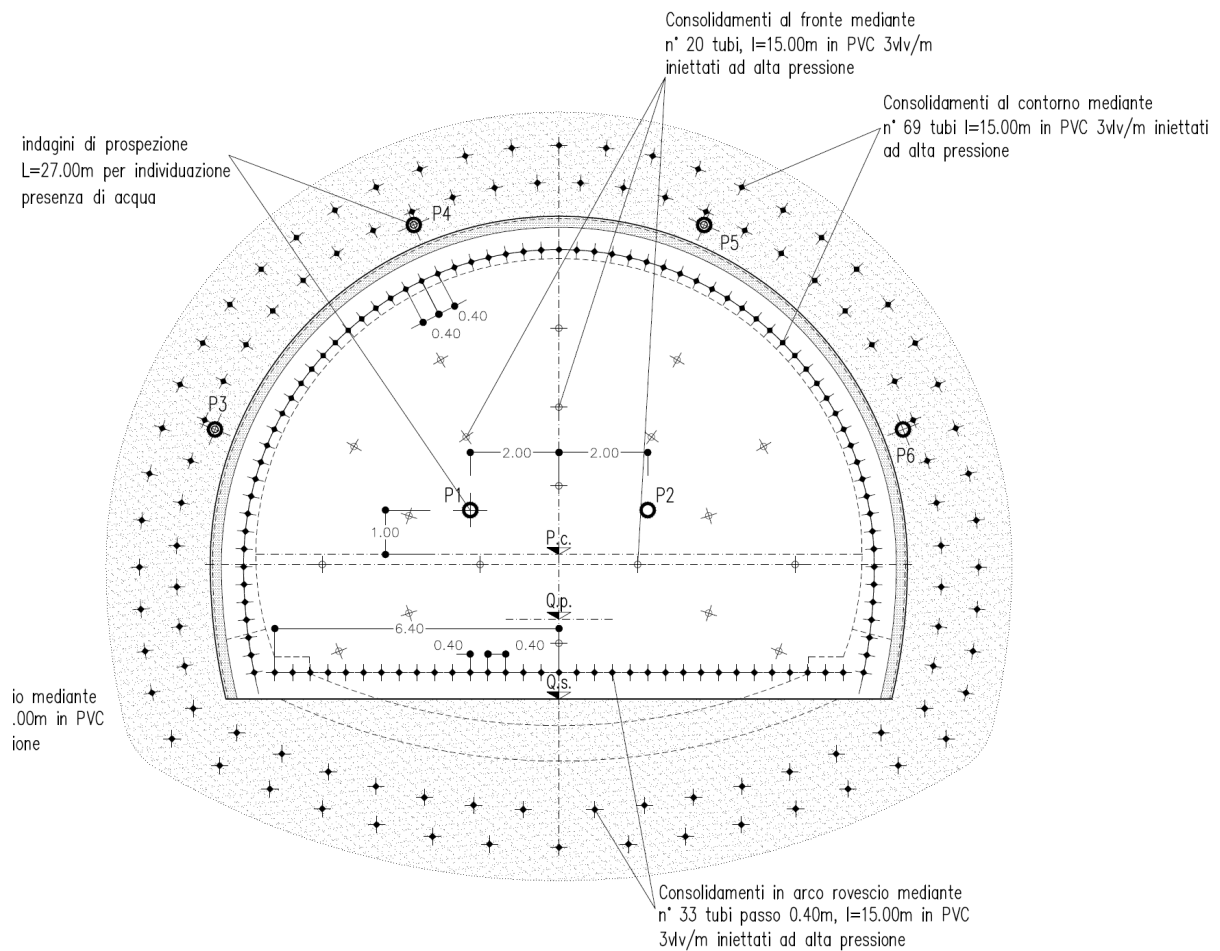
Iniezioni di impermeabilizzazione in avanzamento. Schema in sez. trasversale al fronte
